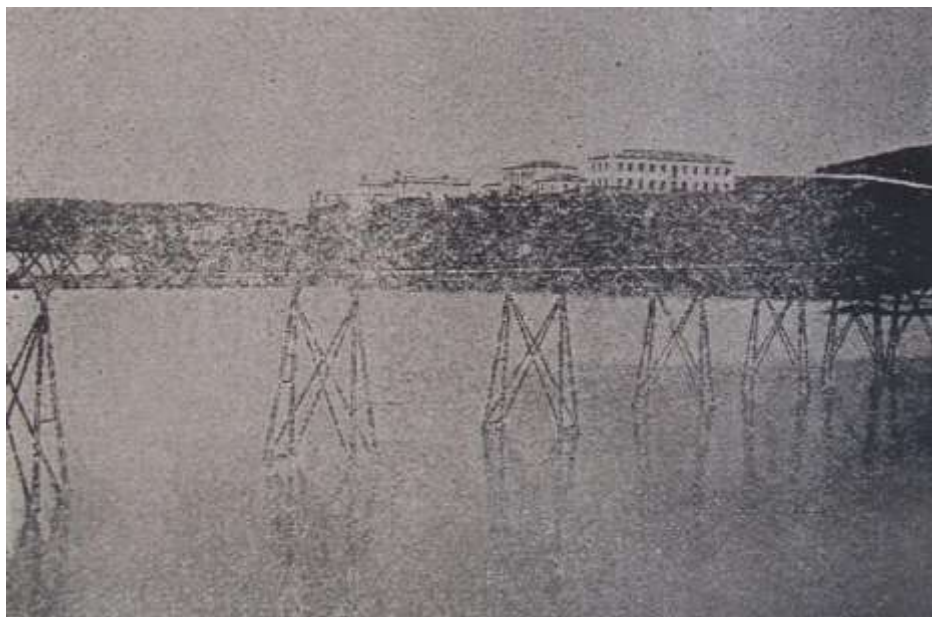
Vista parcial del puente de hierro de Oza. Se aprecian la celosía Warren de la superestructura y los caballetes metálicos triangulares de apoyo. Al fondo, sobre las lomas, los pabellones del lazareto limpio, al sur de la playa [16].
